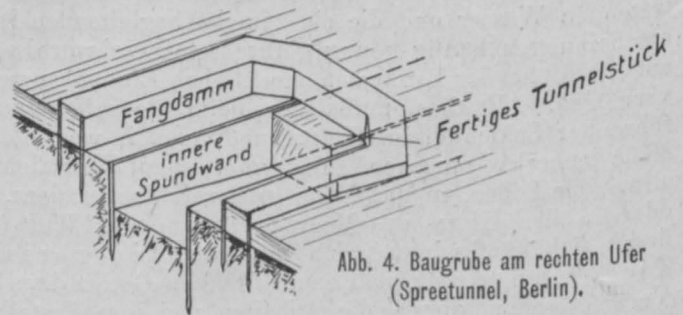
Baugrube am rechten Ufer (Spreetunnel, Berlin).
